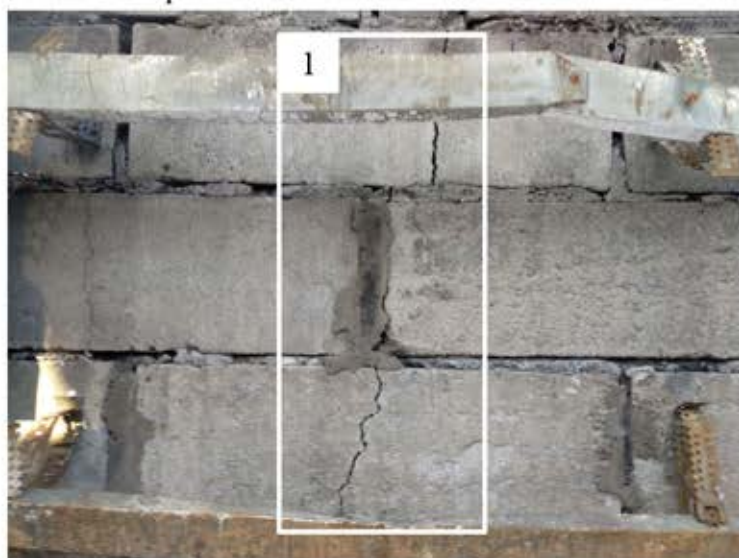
Фрагмент вида стены. Дефекты: 1-трещина в газобетонных блоках
